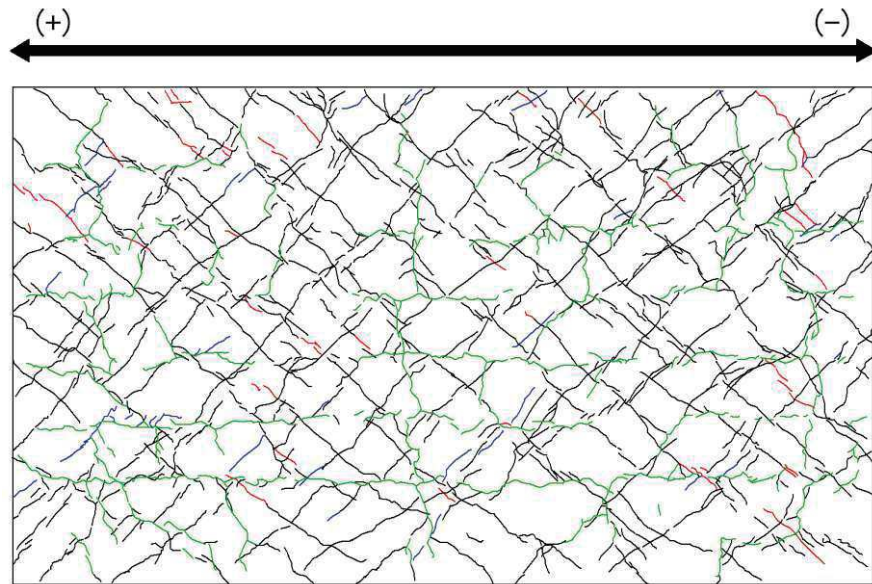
乾燥試験体 [2] 最終破壊時ひび割れ図
